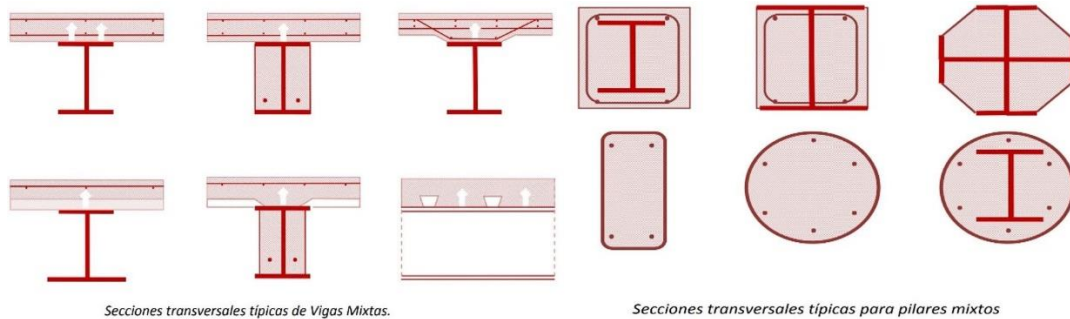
Secciones transversales vigas y pilares mixtos.
